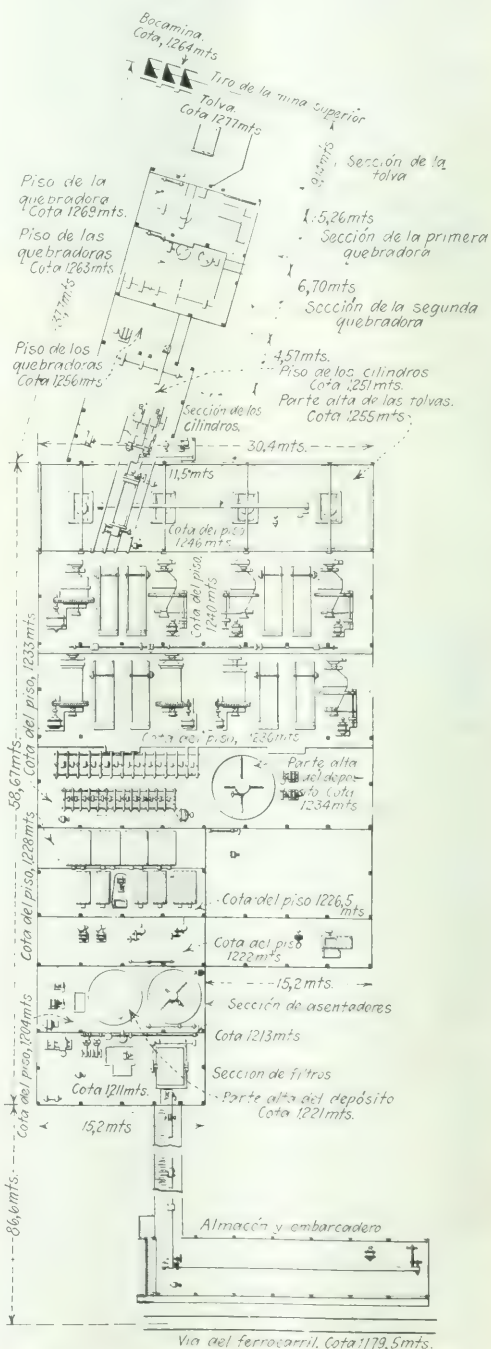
PLANO GENERAL DE LA PLANTA SUPERIOR
